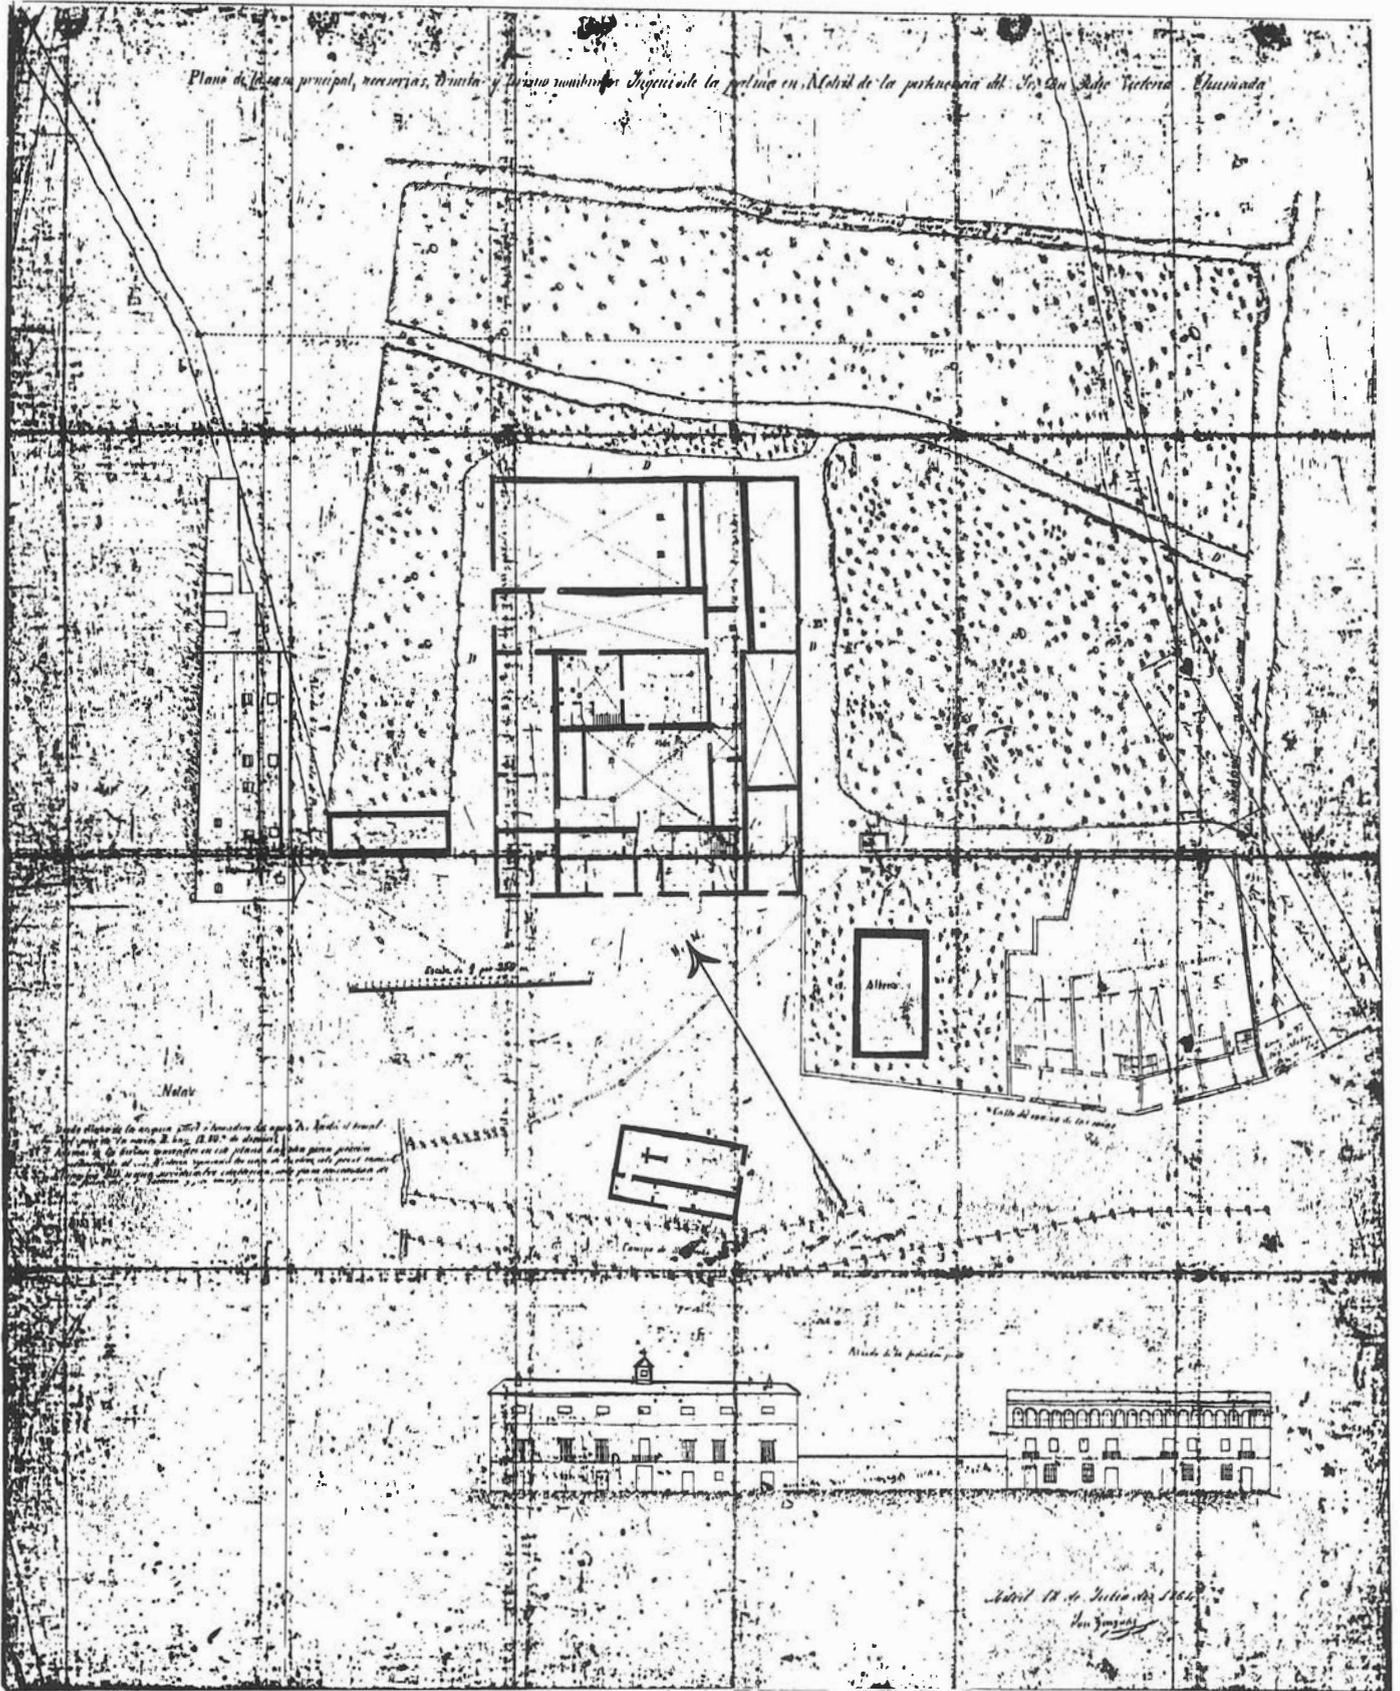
Plano inédito del ingenio de La "Palma" del año 1864. Planimetría y alzado del edificio de La Palma interpretado como ingenio azucarero. La zona excavada aparece en la planta como un espacio abierto.
